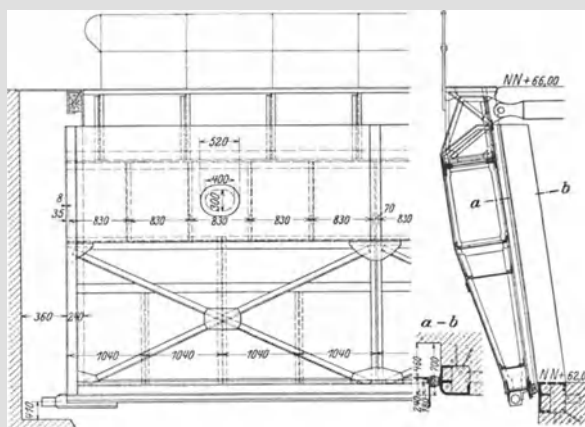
a u. b. Klapptor. Schleuse Bolzum.
